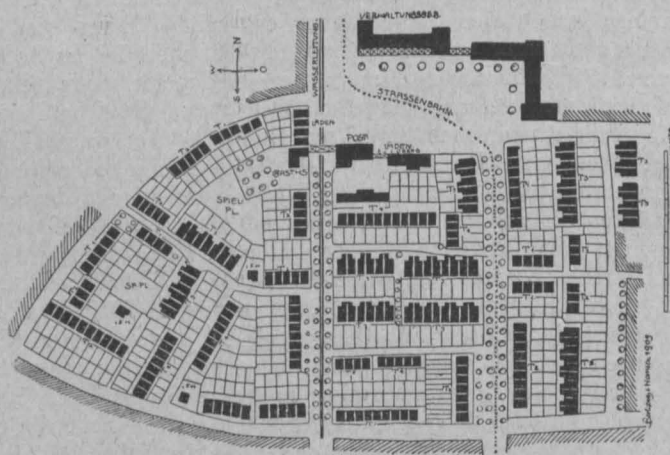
Gartenstadt München-Perlach, Detailplan der Siedlung „Zentrum“
